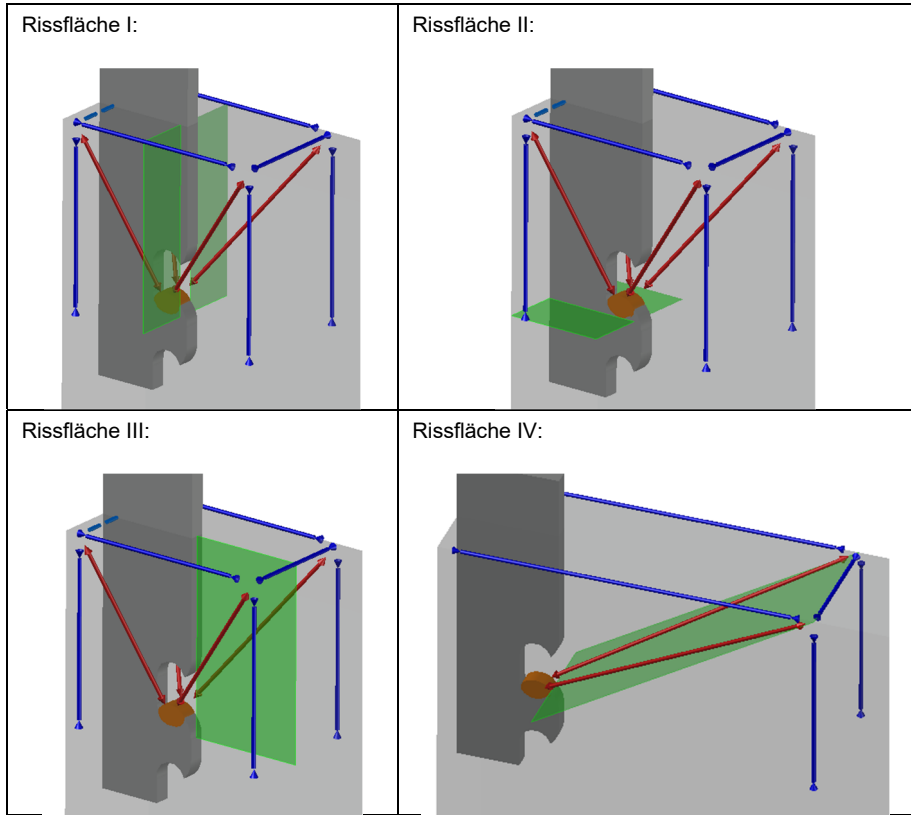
Sekundäres Traglastmodell der Kraftverteilung im Zugversuch nach dem ersten Betonausbruchkegel: Druckstreben (rot) und Zugstreben (blau)
